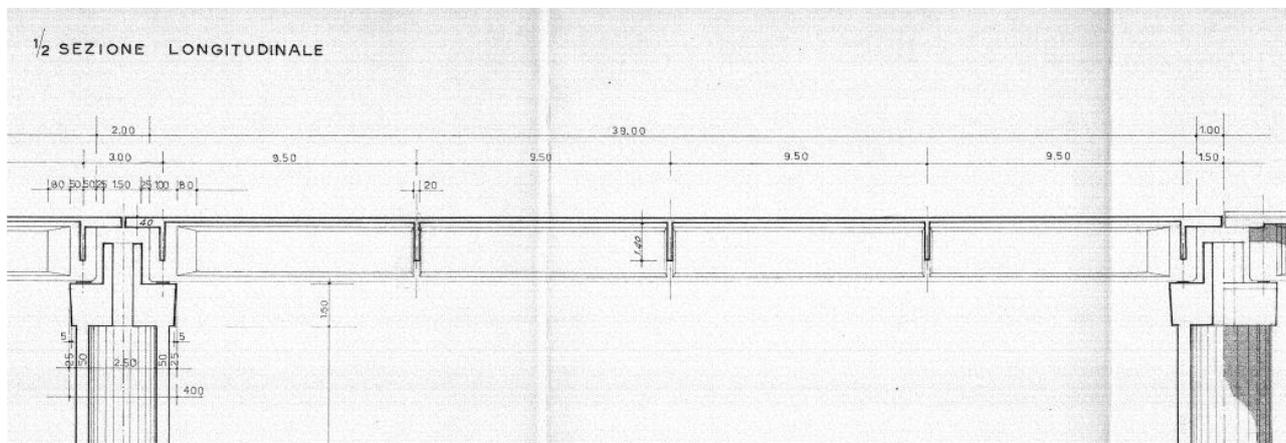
Impalcato a 4 travi in CAP – Sezione longitudinale
